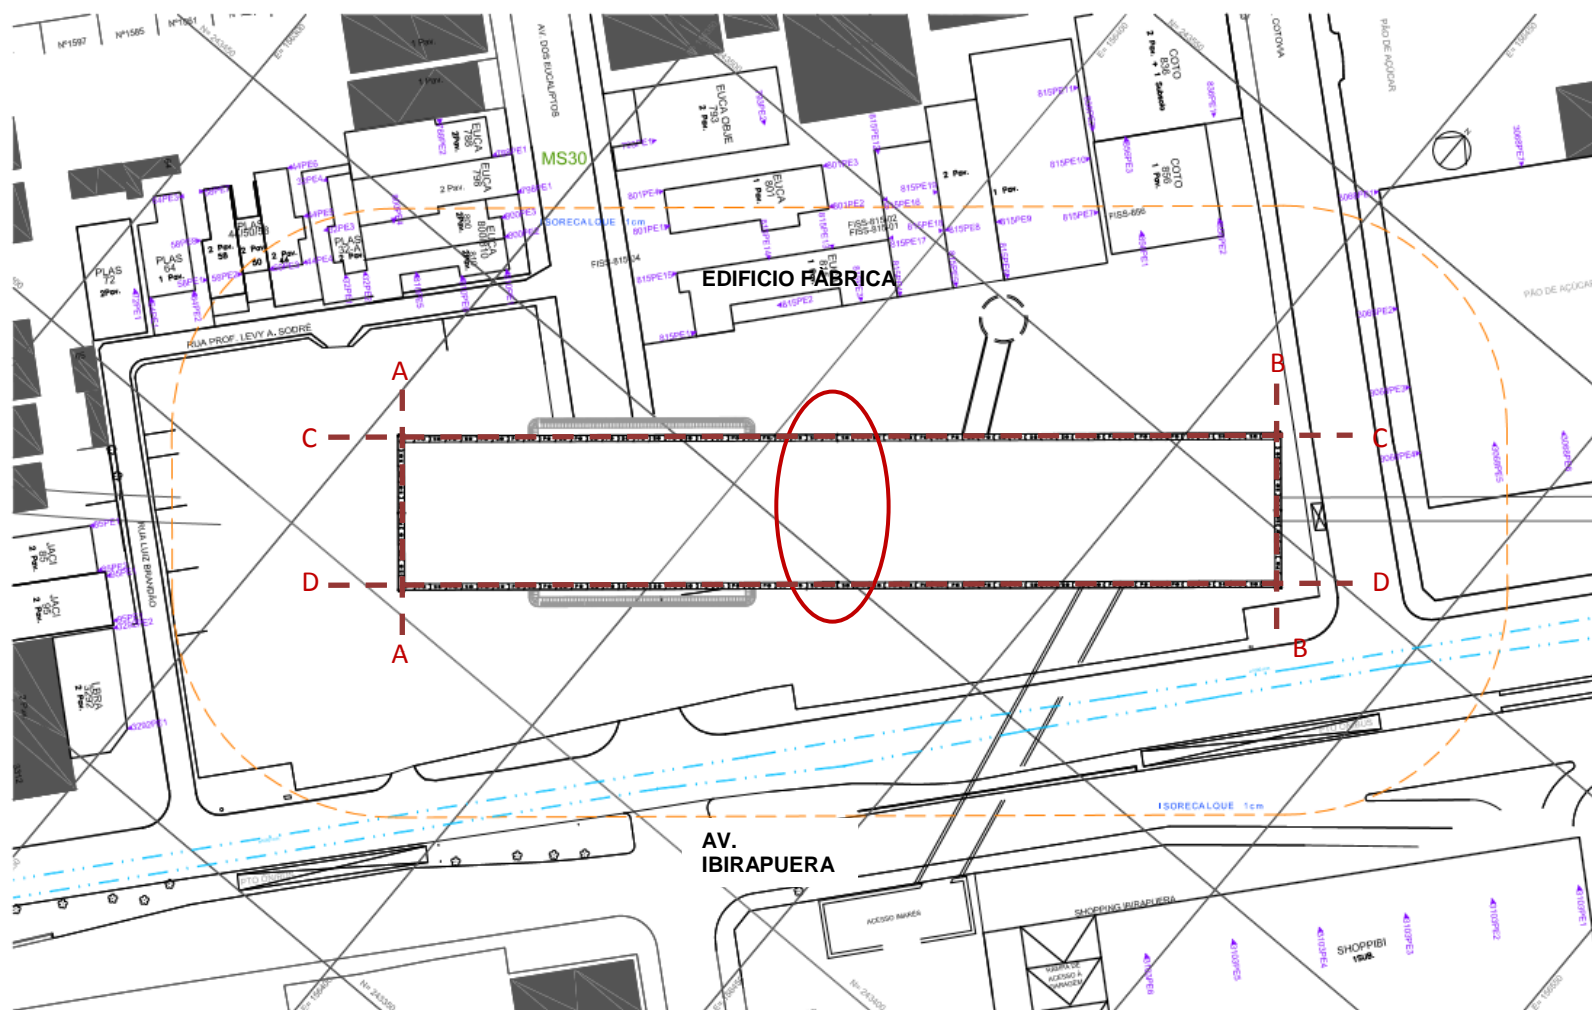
Planta da escavação da Estação Eucaliptos, zona assinalada com elipse vermelha indica a zona alvo de estudo (SC06), s/ escala (adaptado à peça desenhada cedida pela Companhia de Metropolitano de São Paulo).
